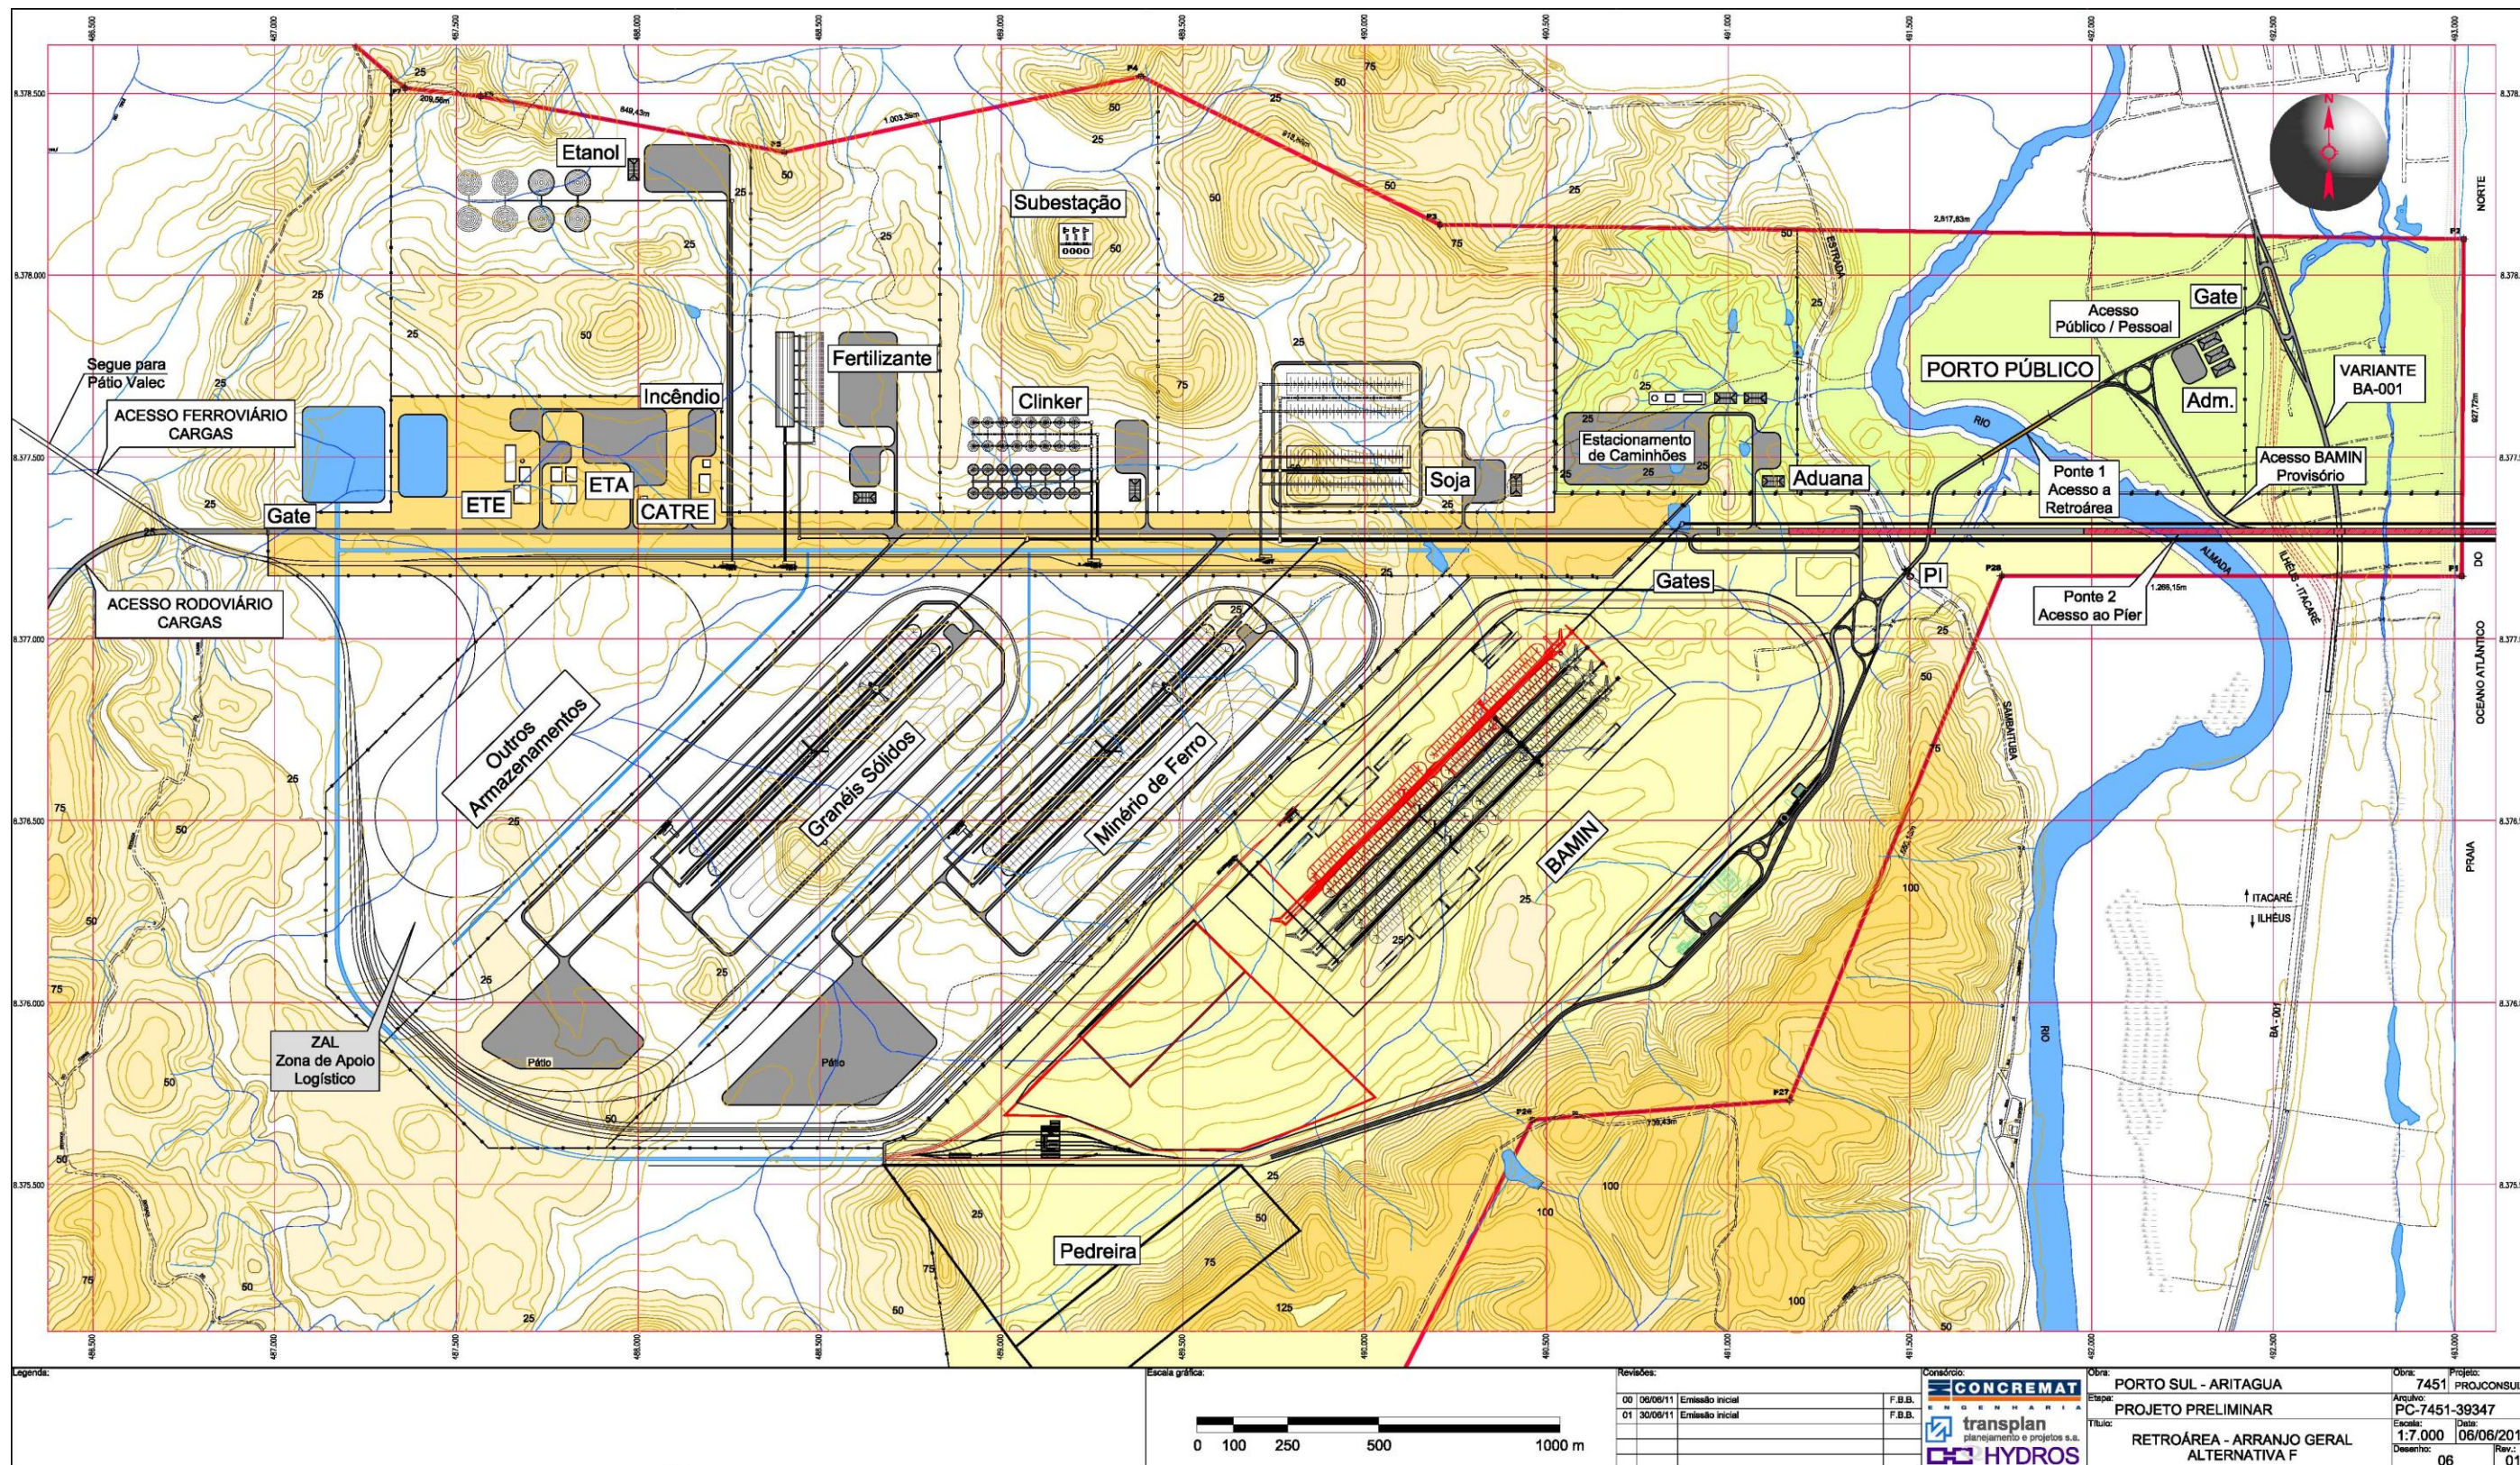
Planta Planialtimétrica Porto Sul – Estruturas Onshore
